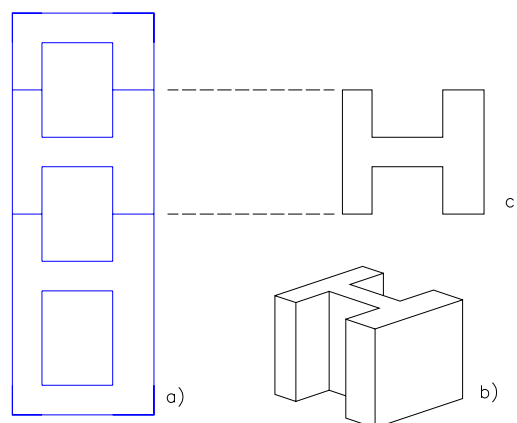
a) Vista en planta del muro de reacción vertical; b) vista en isométrica de la sección "I" (discretización); c) Viga "I" aislada
